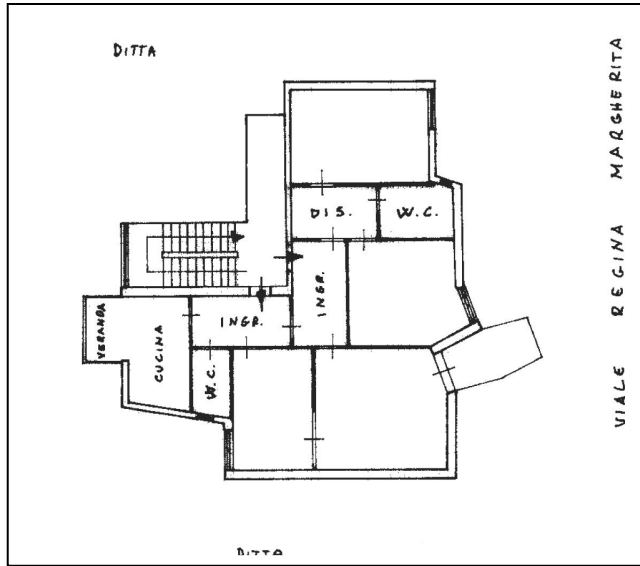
Estratto planimetria catastale del 14/05/1986
